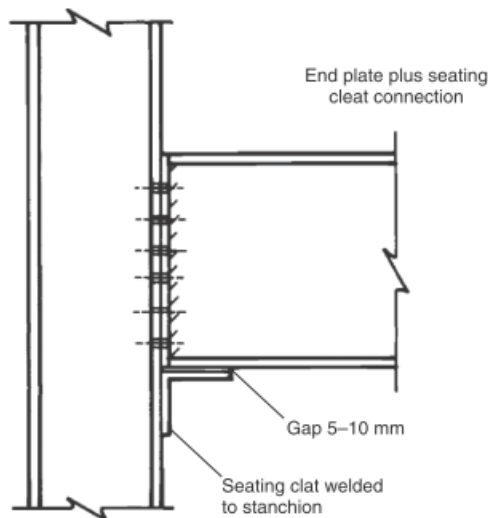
Nodo strutturale di connessione tra trave e pilastro.
